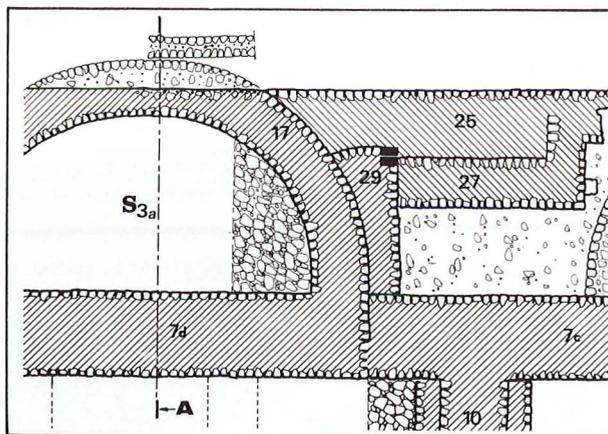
Abside de la salle S3, avec retaille tangentielle - Plan et coupe.
